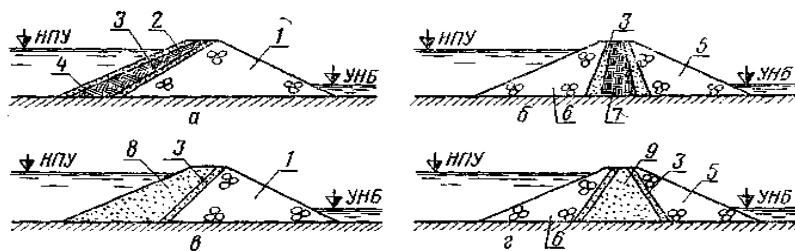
Виды каменно-грунтовых плотин:
